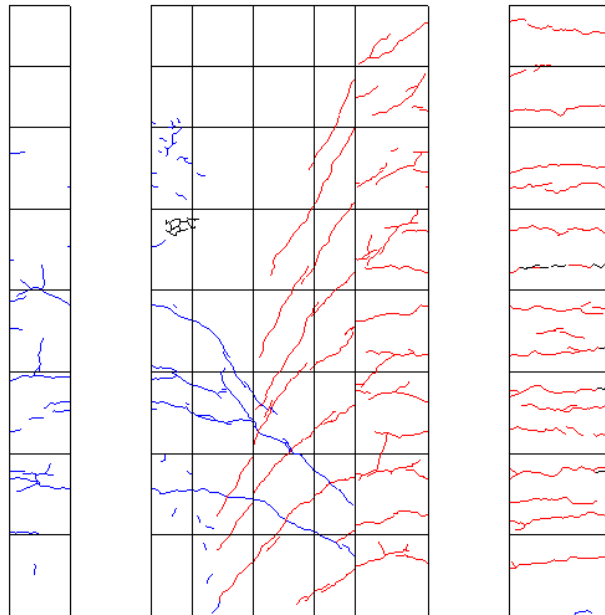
R=1/100②ひび割れ図
